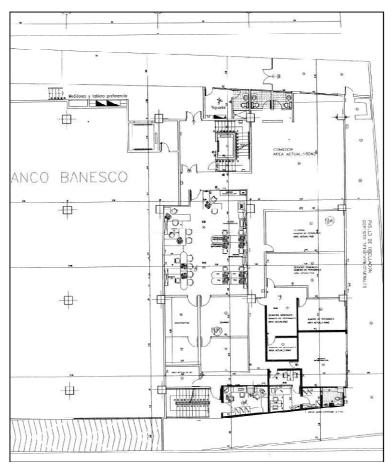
Plano de la Planta Baja del Edif. Araguaney.
